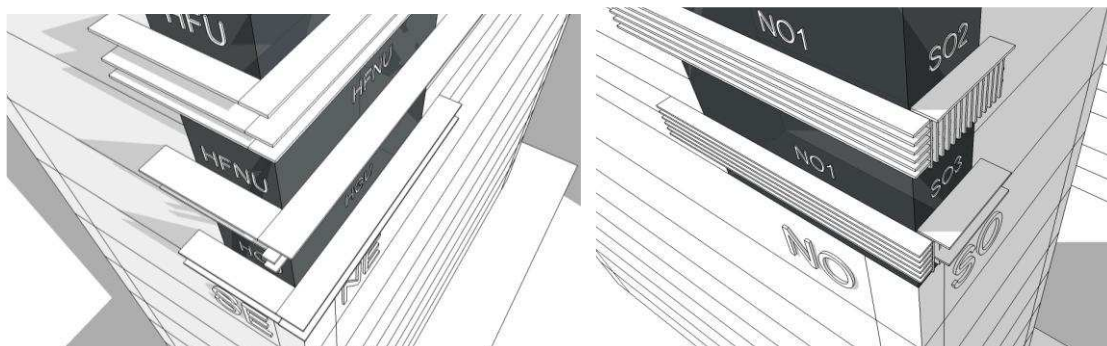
Fachada Sudeste-Nordeste 21 jun 9h. Fachada Noroeste-Sudoeste 21 set 15h.
